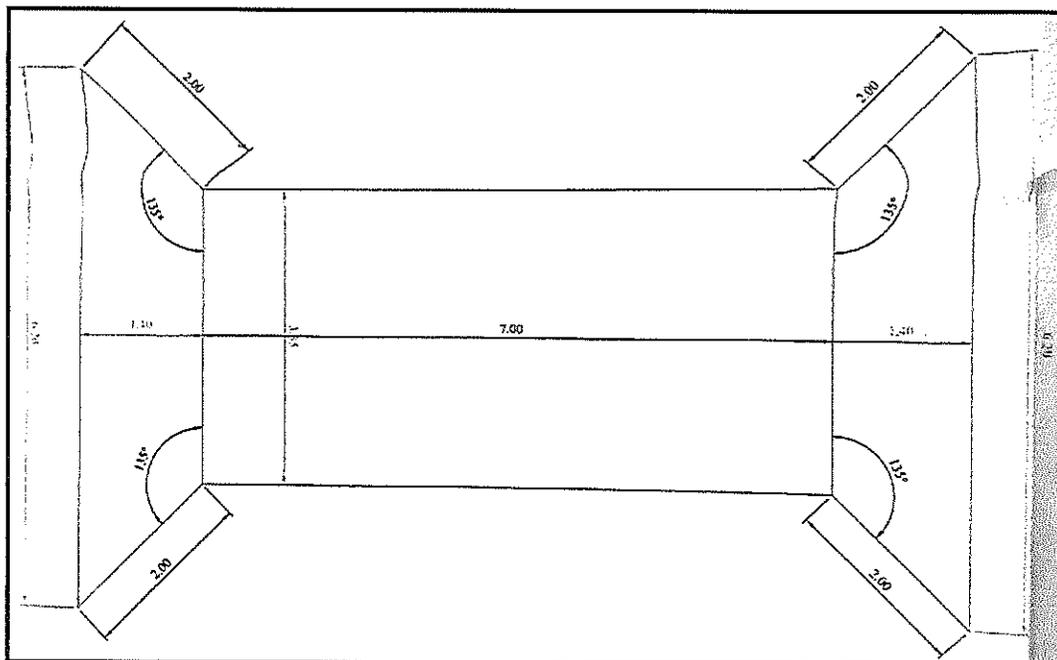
Sección Transversal de la alcantarilla proyectada. Fuente: Planos entregados por el Solicitante.
